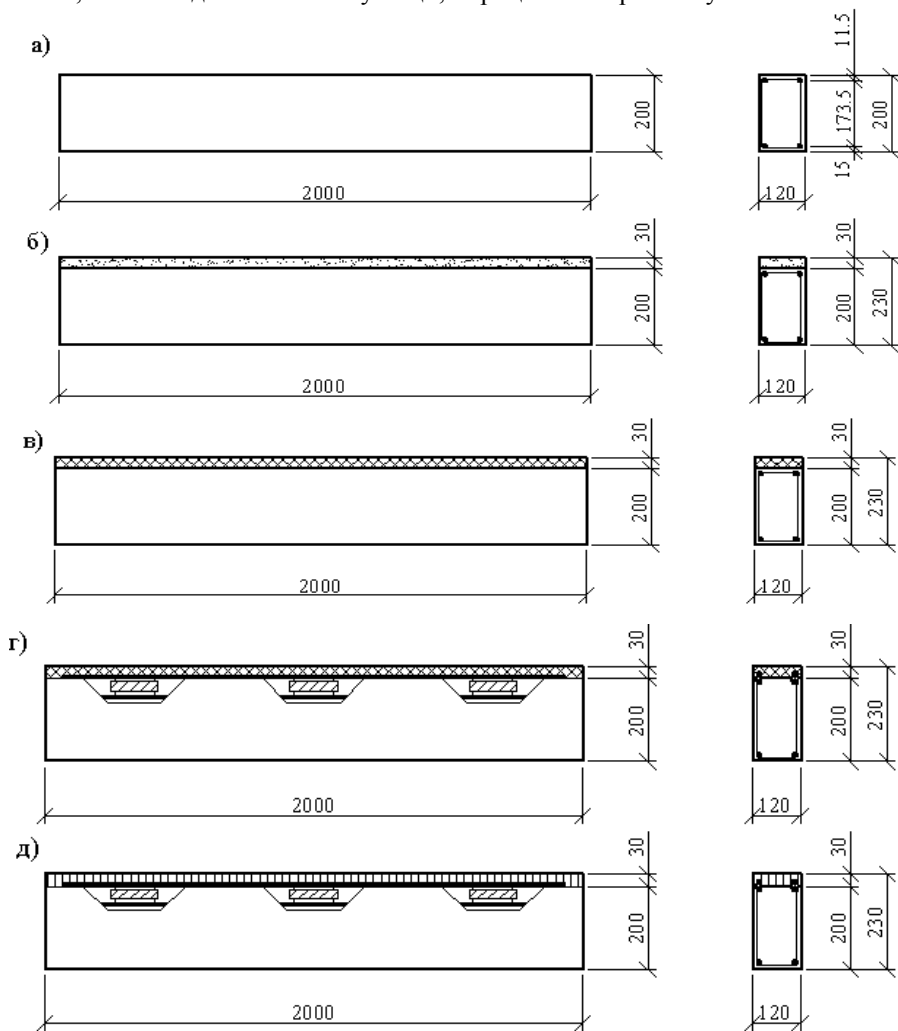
Принципова схема конструювання п'яти серій експериментальних балок: а) невідсилена (Б); б) відсилена сталевібробетоном (БС); в) відсилена полімербетоном (БП); г) відсилена полімербетоном і арматурою (БП_А); д) відсилена арматурою та дрібнозернистим бетоном (БТ)
